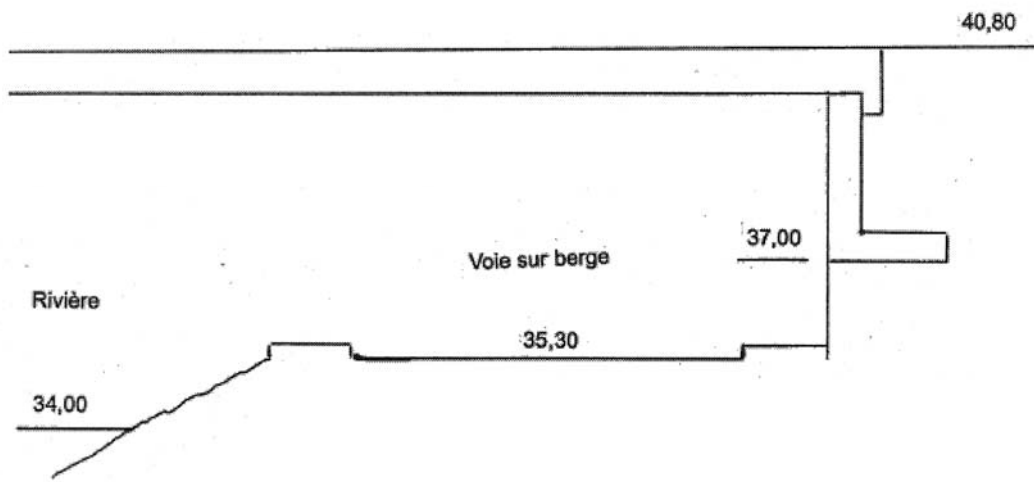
Profil au droit de la culée de l'ouvrage : état final.
